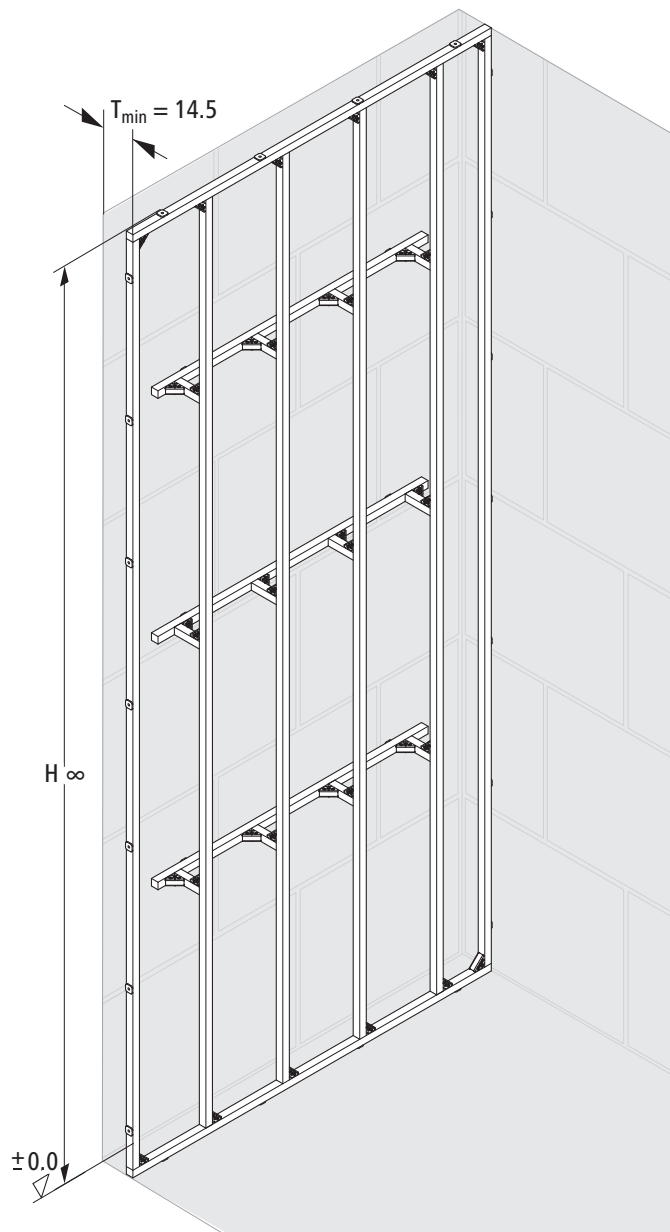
Cadre de montage Optivis, à la hauteur voulue
